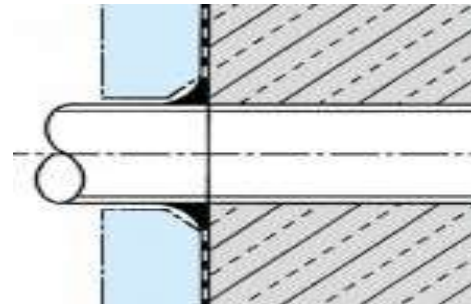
Beispiel für eine Rohrdurchdringung durch eine Wand bei W2-E (Grundriss)
